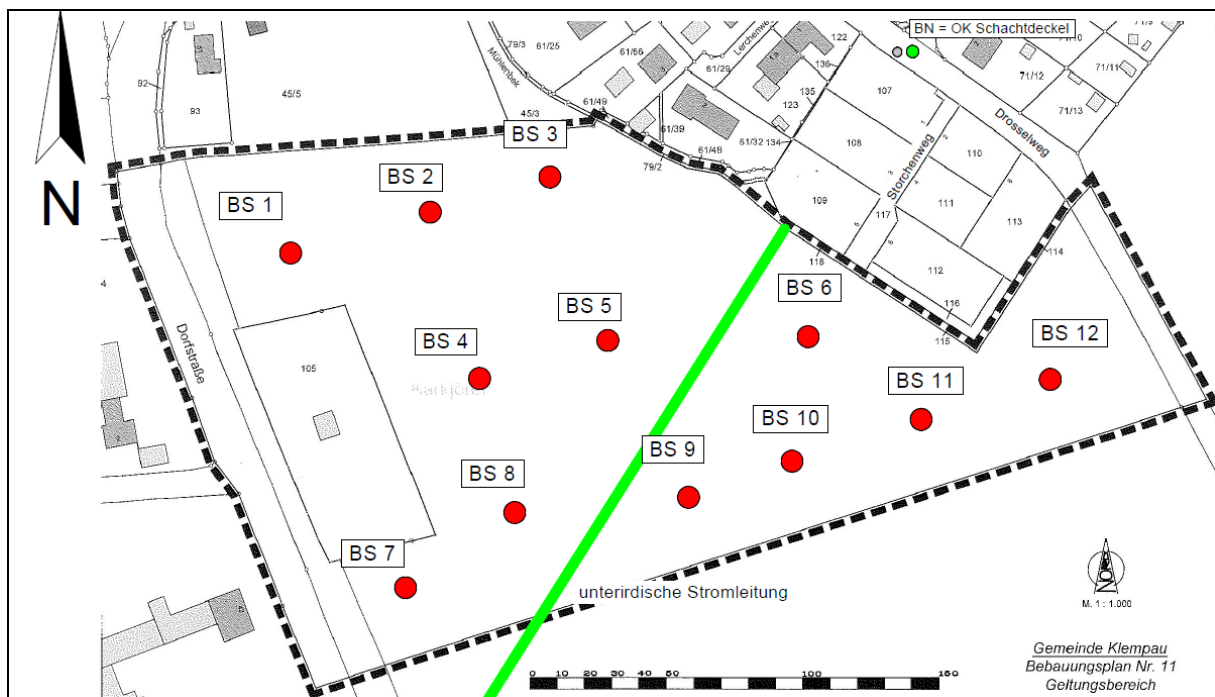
Lageplanskizze mit der Lage der Bohrpunkte BS 1 - BS 12 (Quelle: Baugrunduntersuchung vom 22.03.2022)
